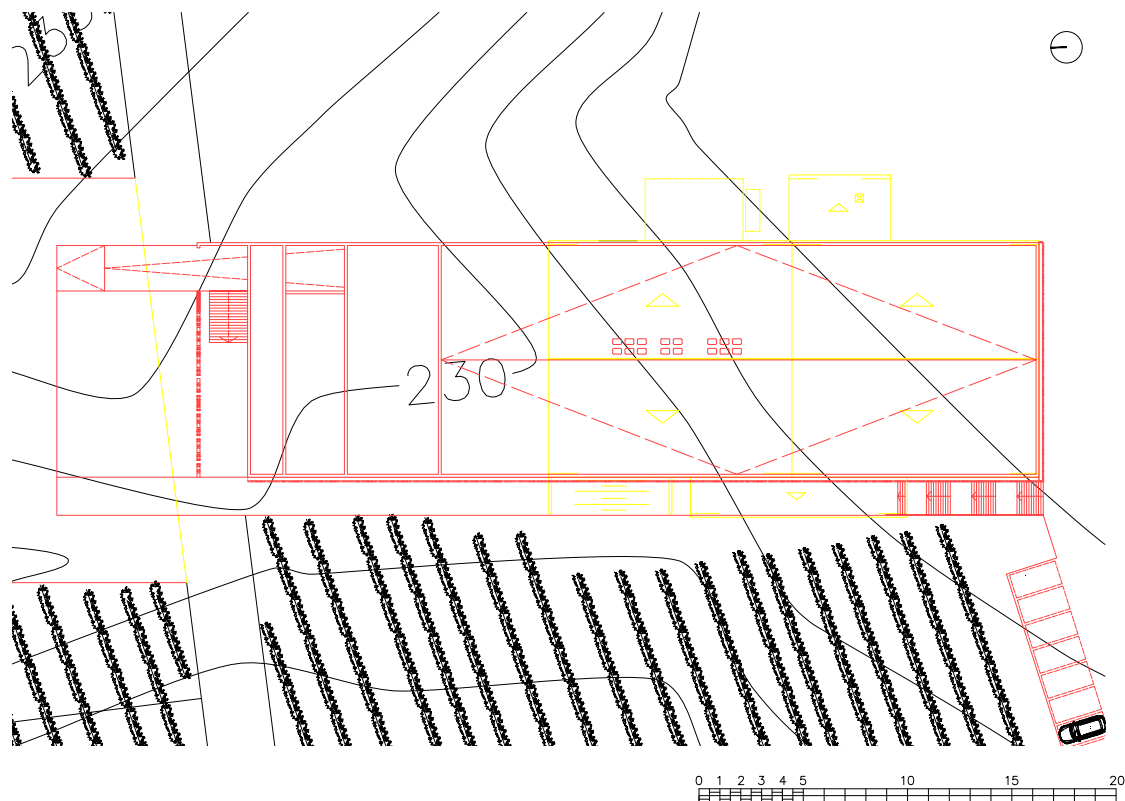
Planta de Cobertura Vermelhos/Amarelos Esc.1:200
